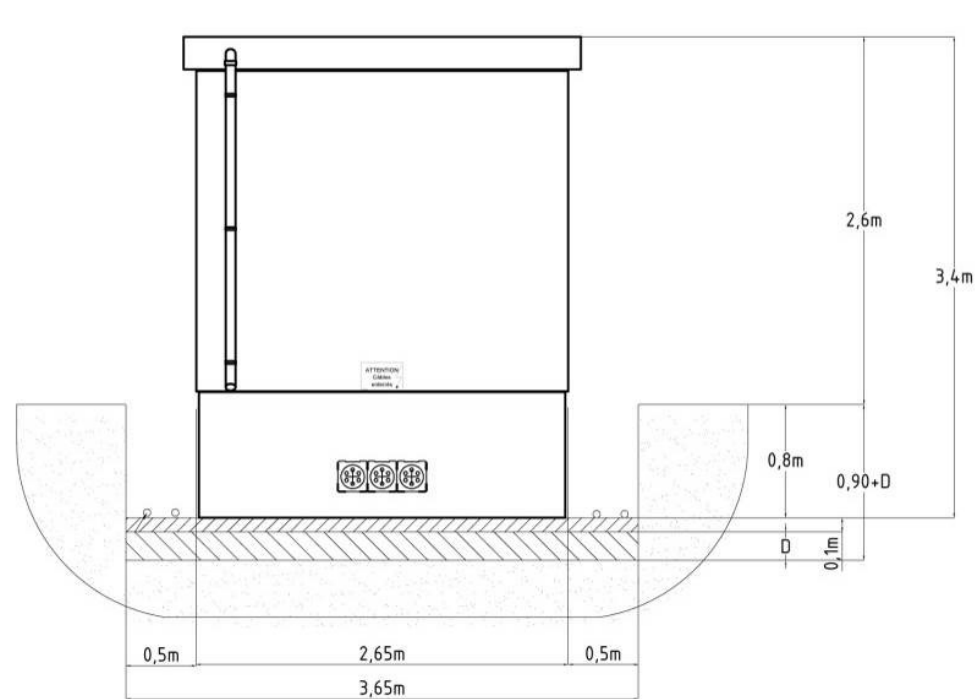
Plan de façade d'un poste de livraison (vue de profil)
